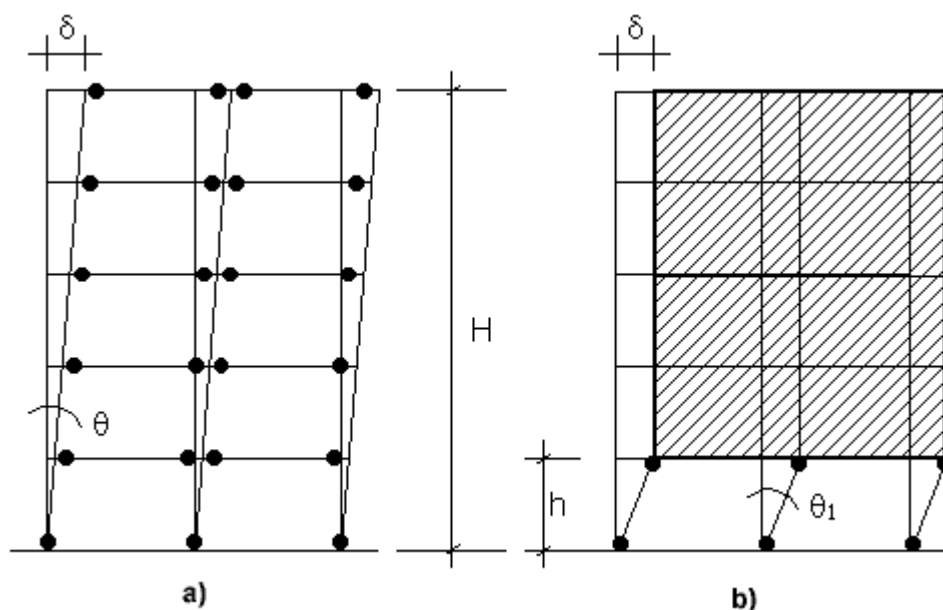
Meccanismi di plasticizzazione; (a) cerniere nelle travi ed alla base dei pilastri; (b) cerniere ai pilastri del piano terra
